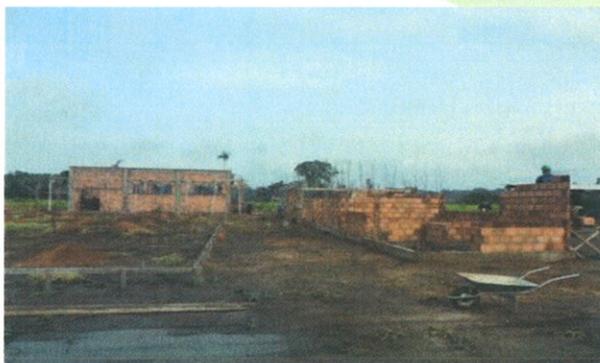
Acompanhamento da construção civil da agroindústria de Nazaré, em 9 de dezembro de 2016.
